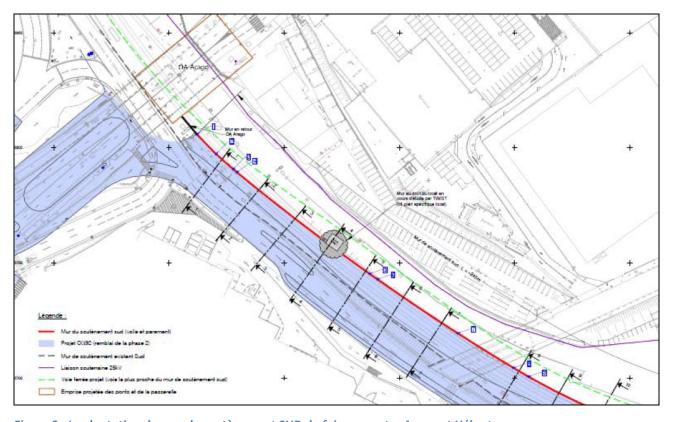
Implantation du mur de soutènement SUD du faisceau entre Arago et Hébert
